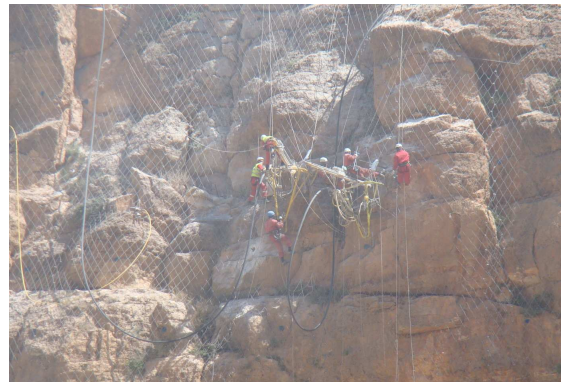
Travaux de mise en place de la maille spider et des ancrages pour soutènement des blocs instables
